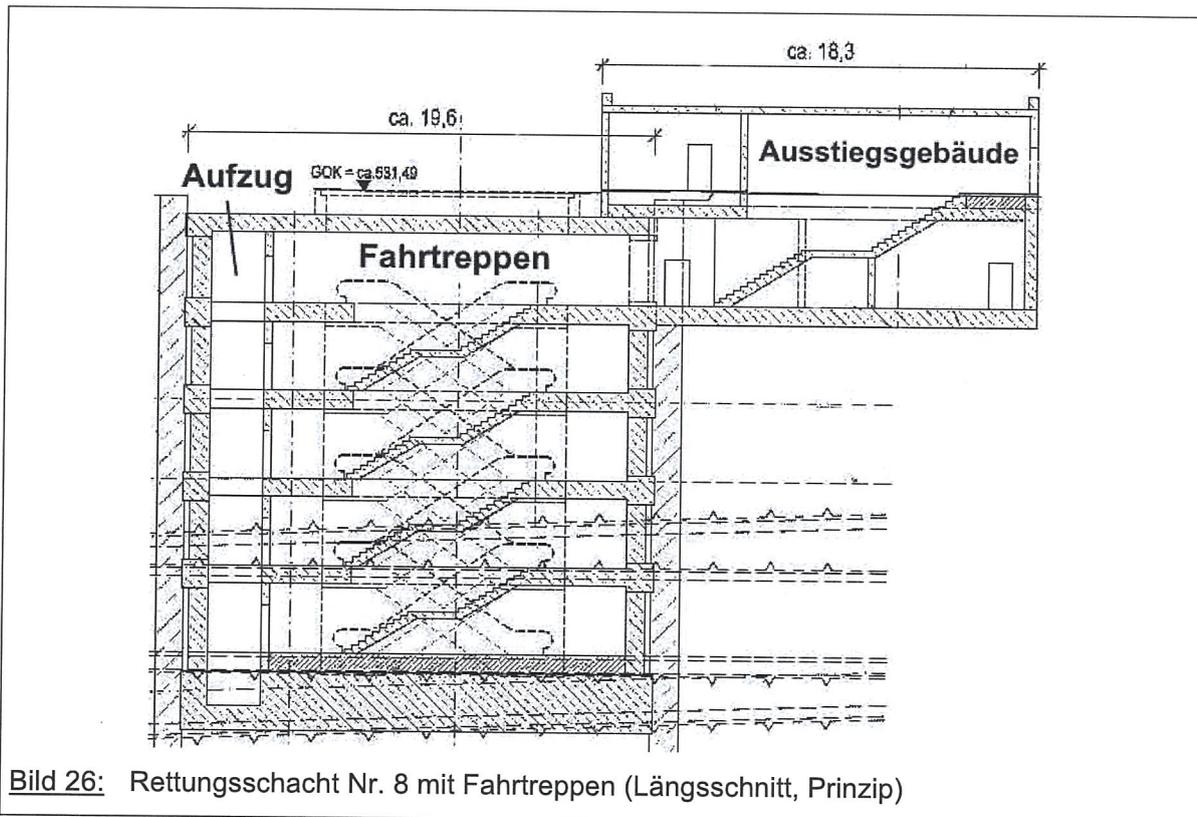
Rettungsschacht Nr. 8 mit Fahrtreppen (Längsschnitt, Prinzip)
